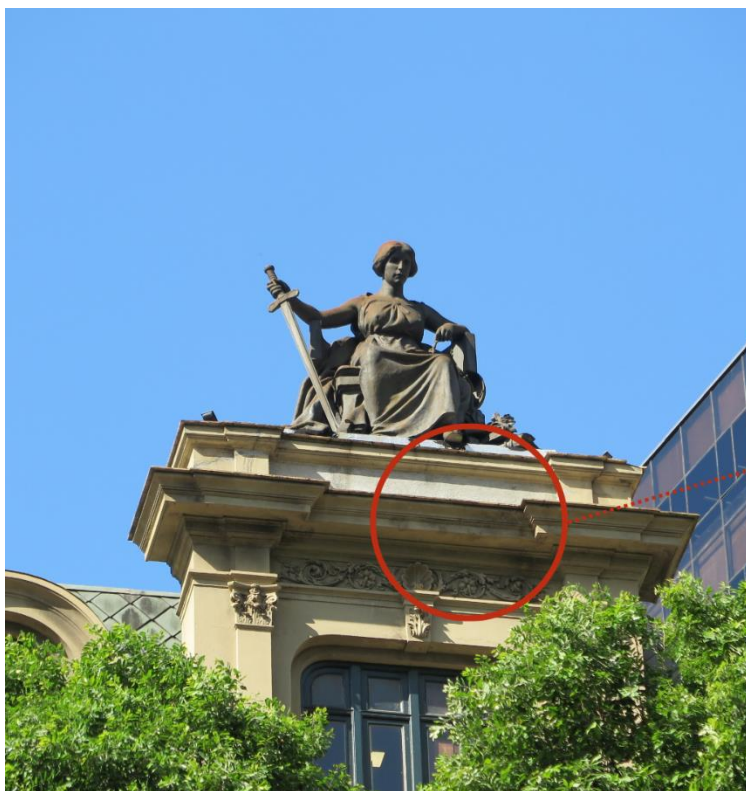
Detalhamento de Danos: Trinca grave na argamassa, gerando infiltração na alvenaria, perigo de queda de partes de argamassa.
